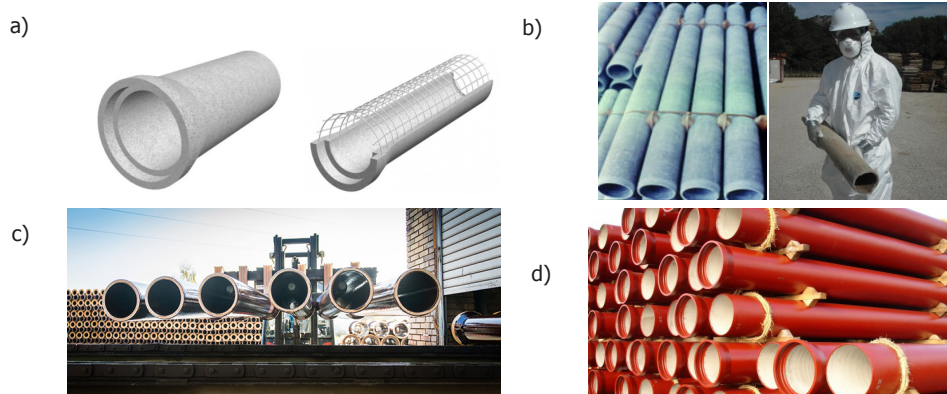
| Tuberías rígidas para saneamiento: a) tuberías de hormigón en masa y hormigón armado, b) fibrocemento, c) gres, d) fundición dúctil.
